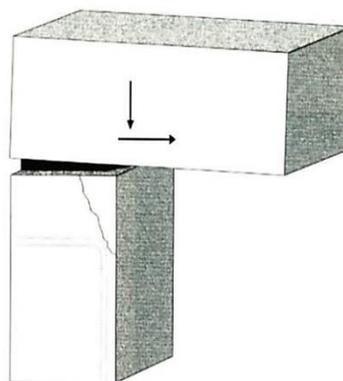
35 PATRÓN DE FRACTURA DE BORDE, POR RIGIDEZ DEL APOYO.
